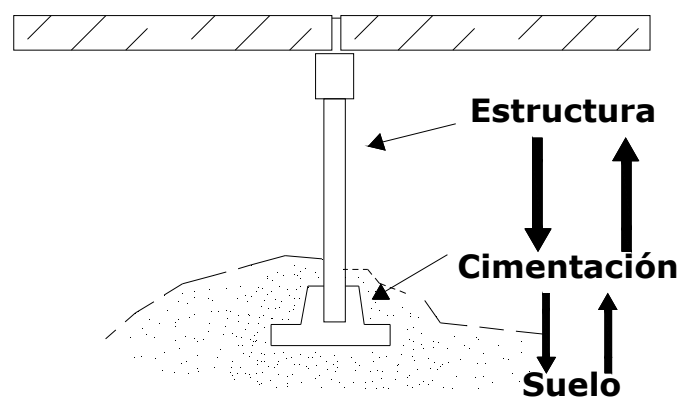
1 Interacción Suelo – Cimentación – Estructura.
